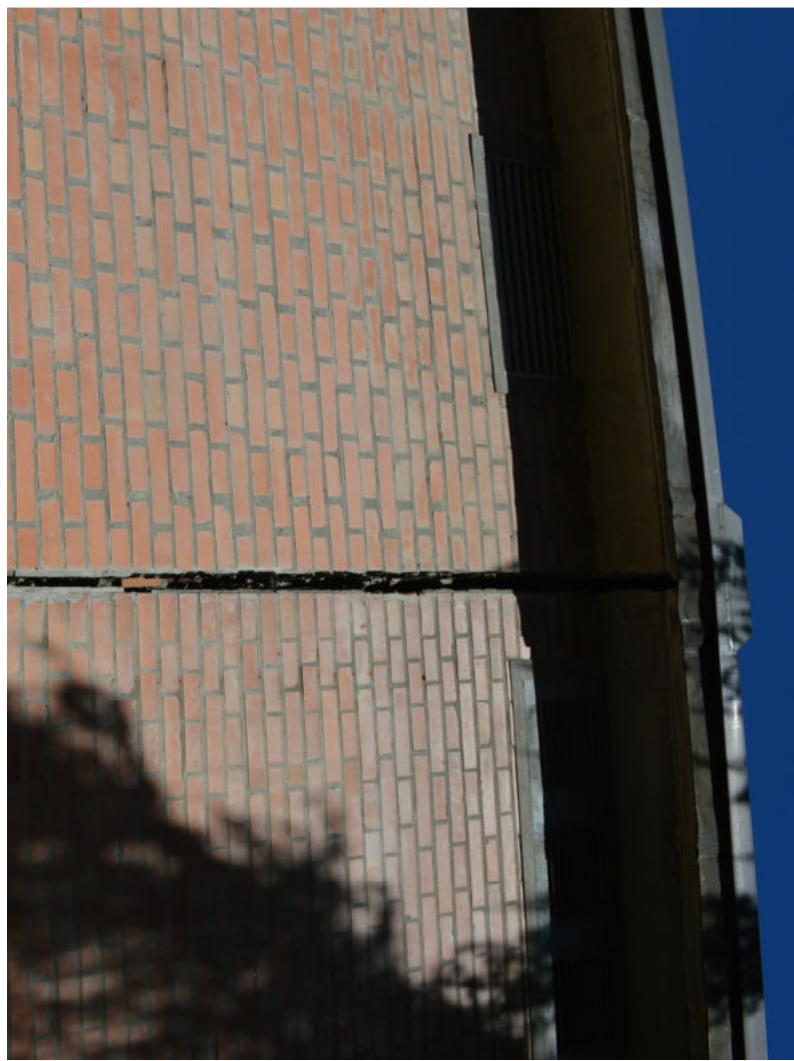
PARTICOLARE LESIONE VERTICALE SUL GIUNTO
